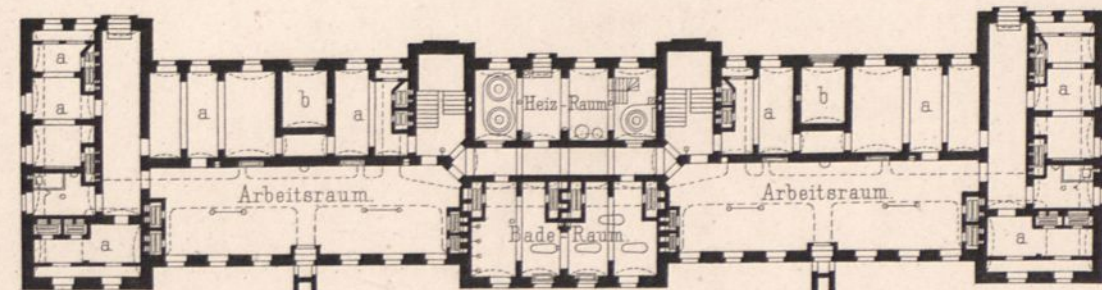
Krankenhaus C. Grundriß des Kellergeschosses.
